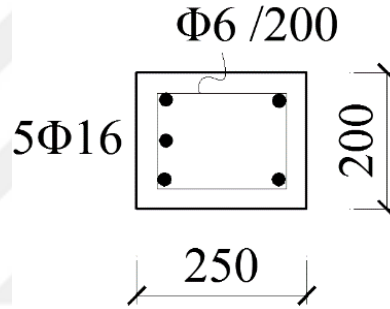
Kolon alt kesiti enkesit görünüşü.
